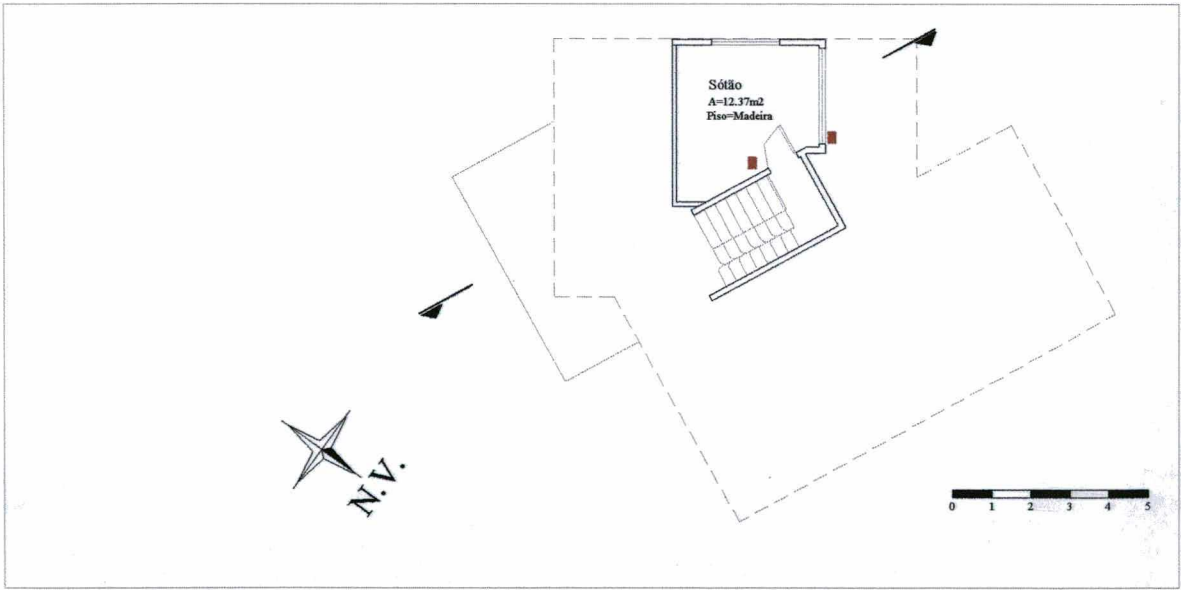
Planta Baixa Pavimento Sótão Residência 1
